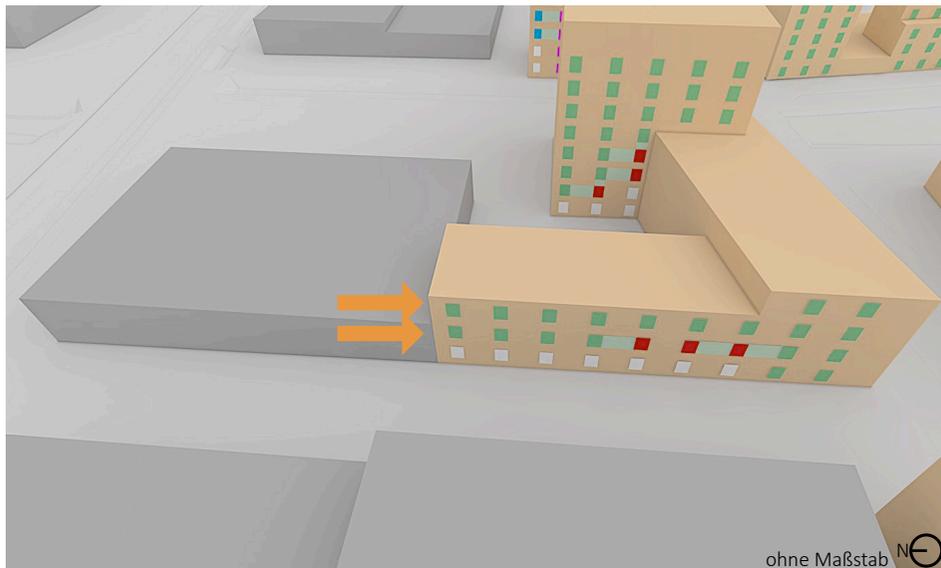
Maßnahme - QN-BF 5 Westfassade - Gebäudestand 26.01.2024
